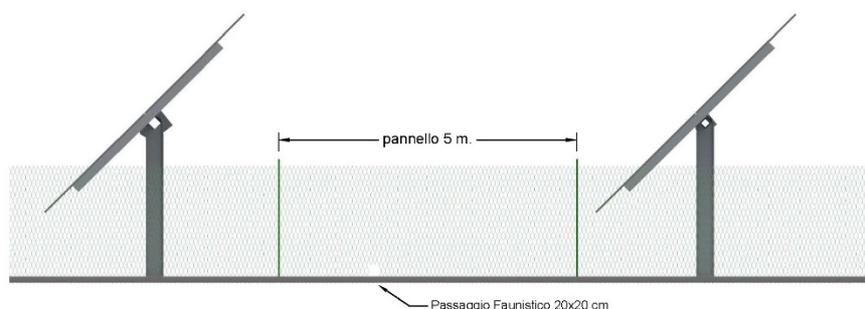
Prospetto recinzione perimetrale senza mitigazione
